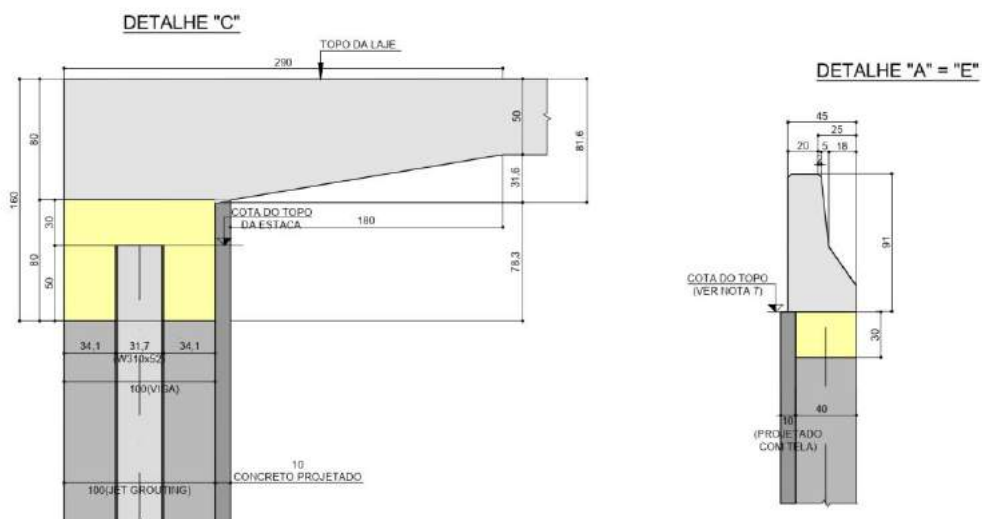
Detalhe da ligação entre a laje e os perfis metálicos das colunas de *jet grouting
